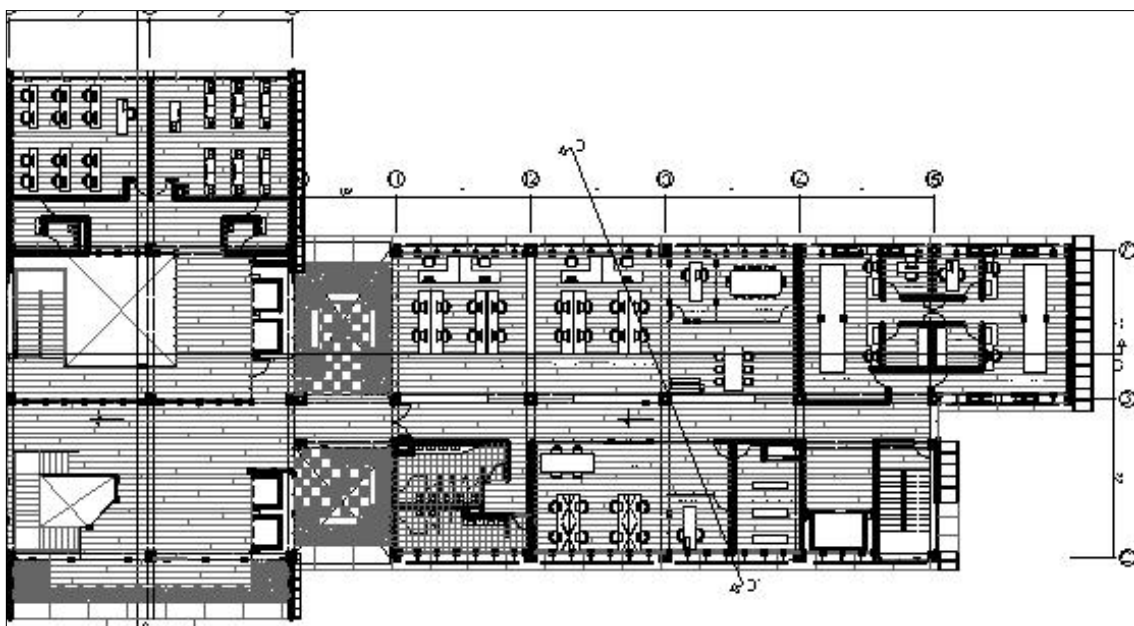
Planta nivel 11.55, lado izquierdo (2017).
